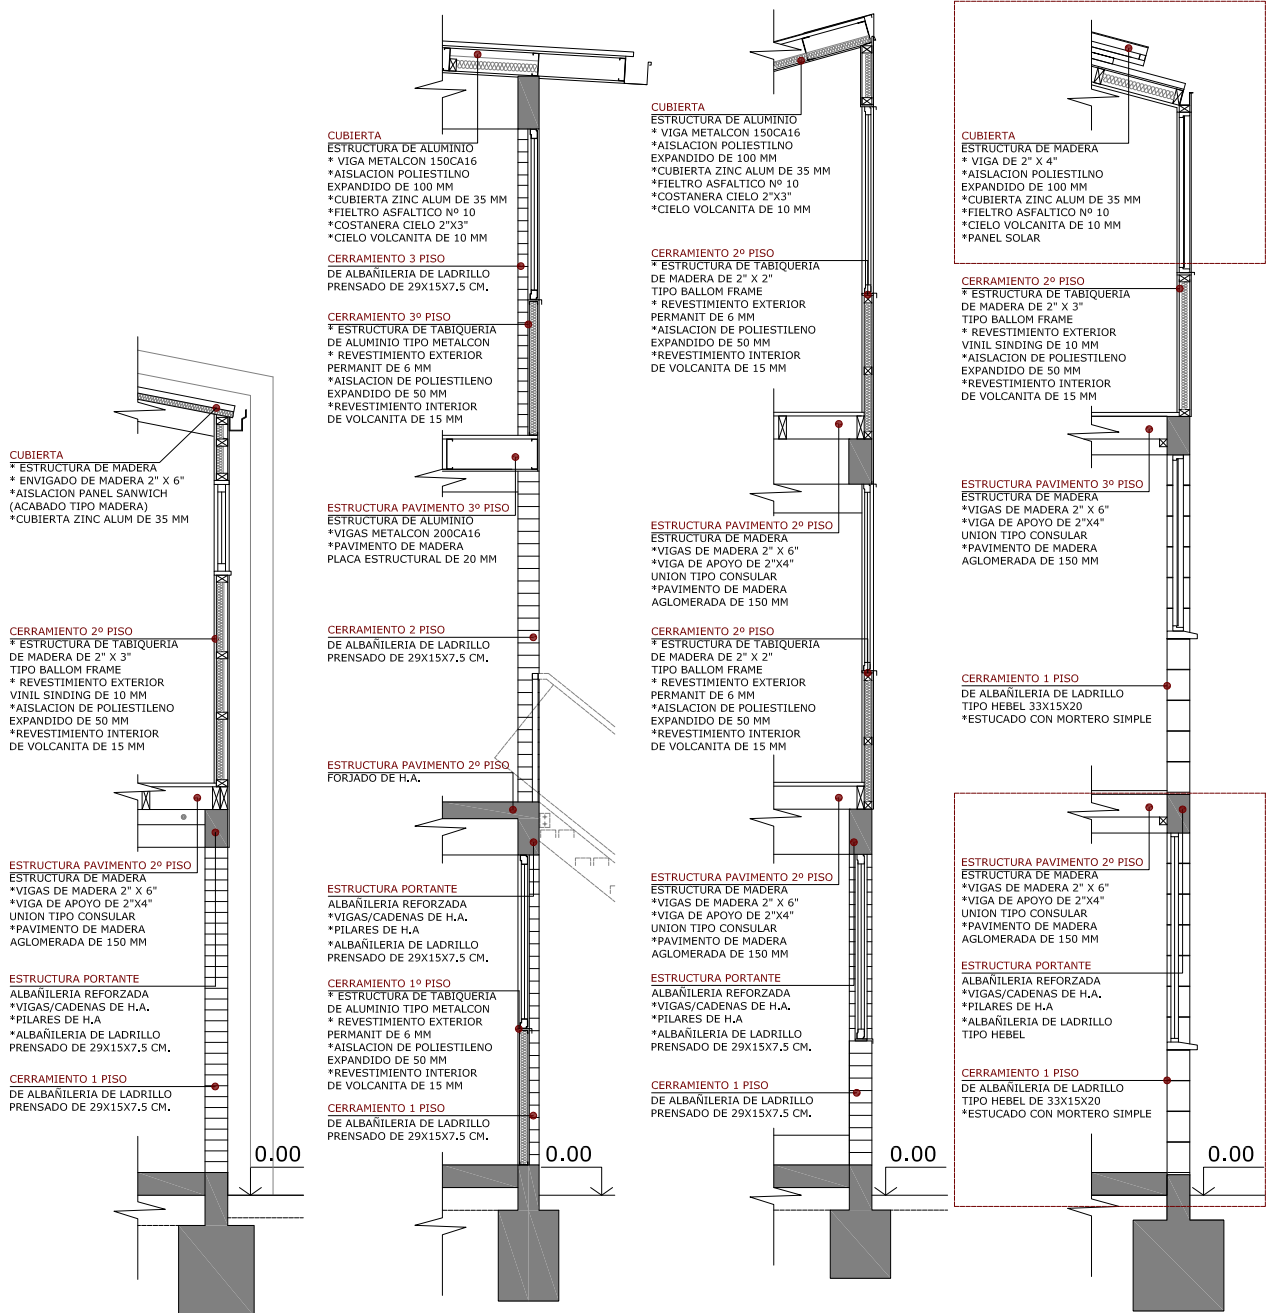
Secciones constructivas, relacion de la estructura portante y cerramiento utilizados
